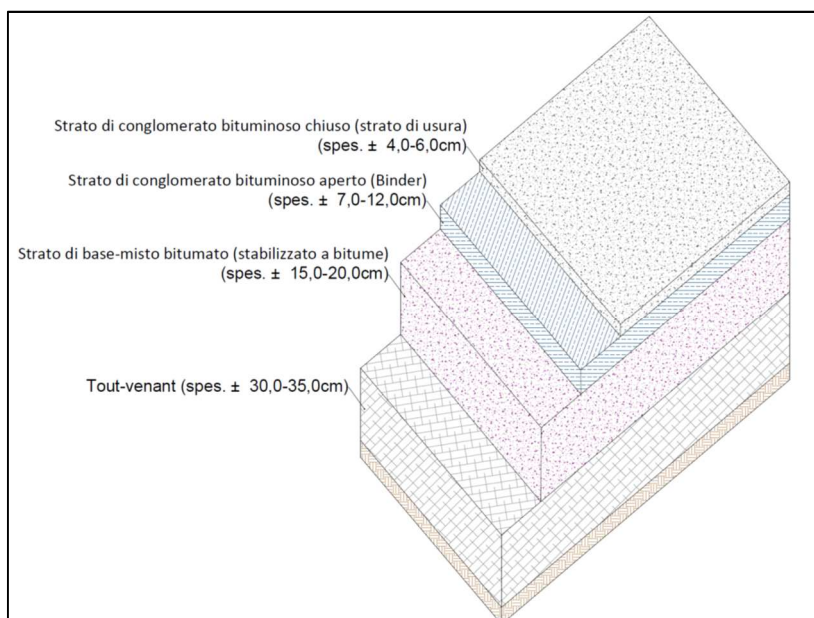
/V: Stratificazione tipo della costruzione della pavimentazione
